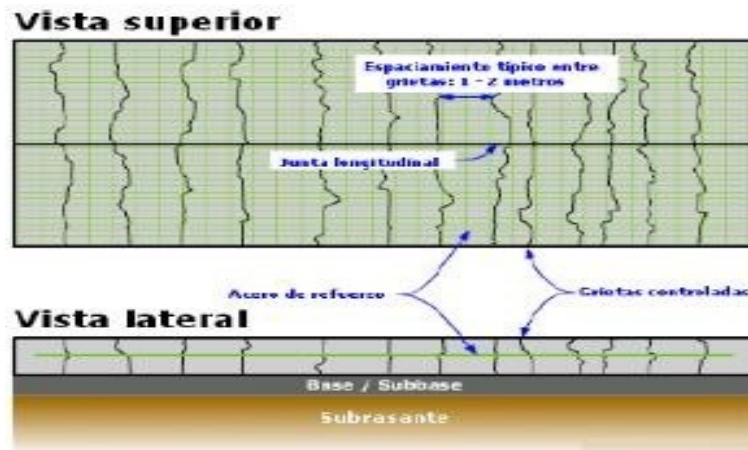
Losa de concreto continuamente reforzada. Fuente: Salgado, M. 2017.
